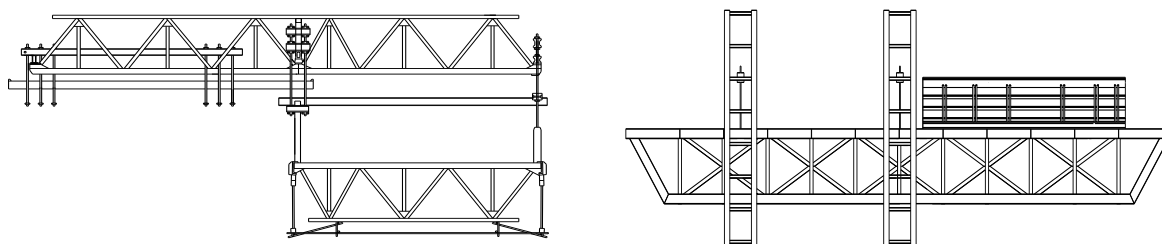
Carros de avanço tipo, à esquerda, carro com sistema de fixação superior (adaptado [11]), à direita, carro com sistema de fixação inferior (adaptado [18])
